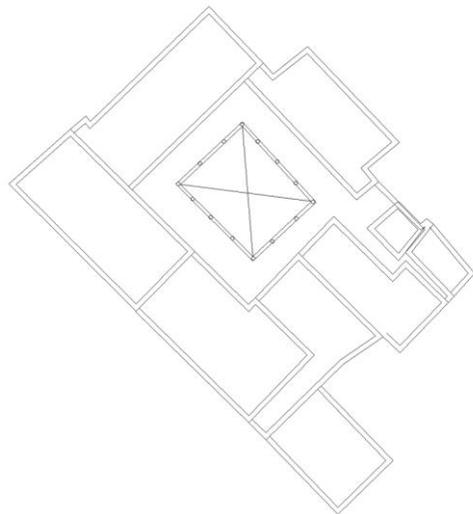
Casa-palacio el Jurado Francisco de Medina - Planta baja.
